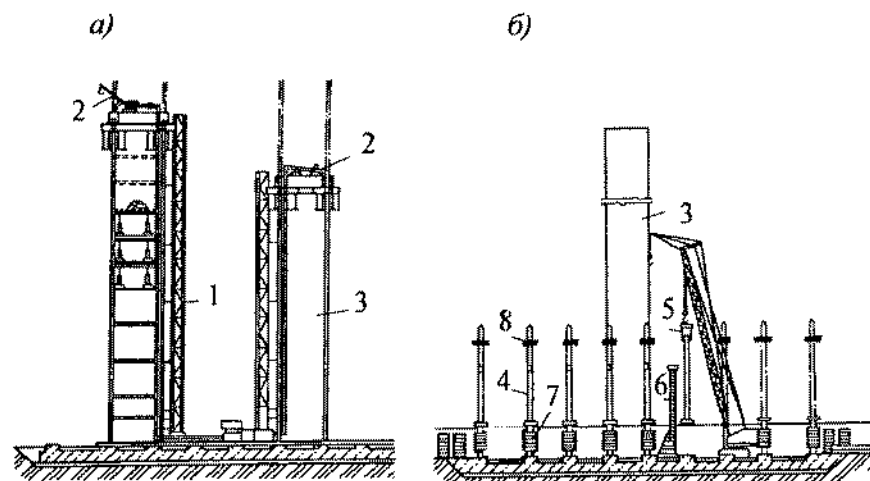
Бетонирование ядра жесткости и монтаж колонн первого яруса:
